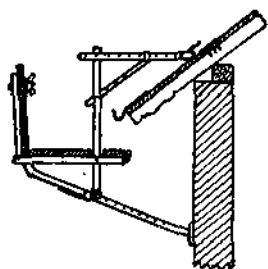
Крюк для подвешивания лестниц к стропилам.
